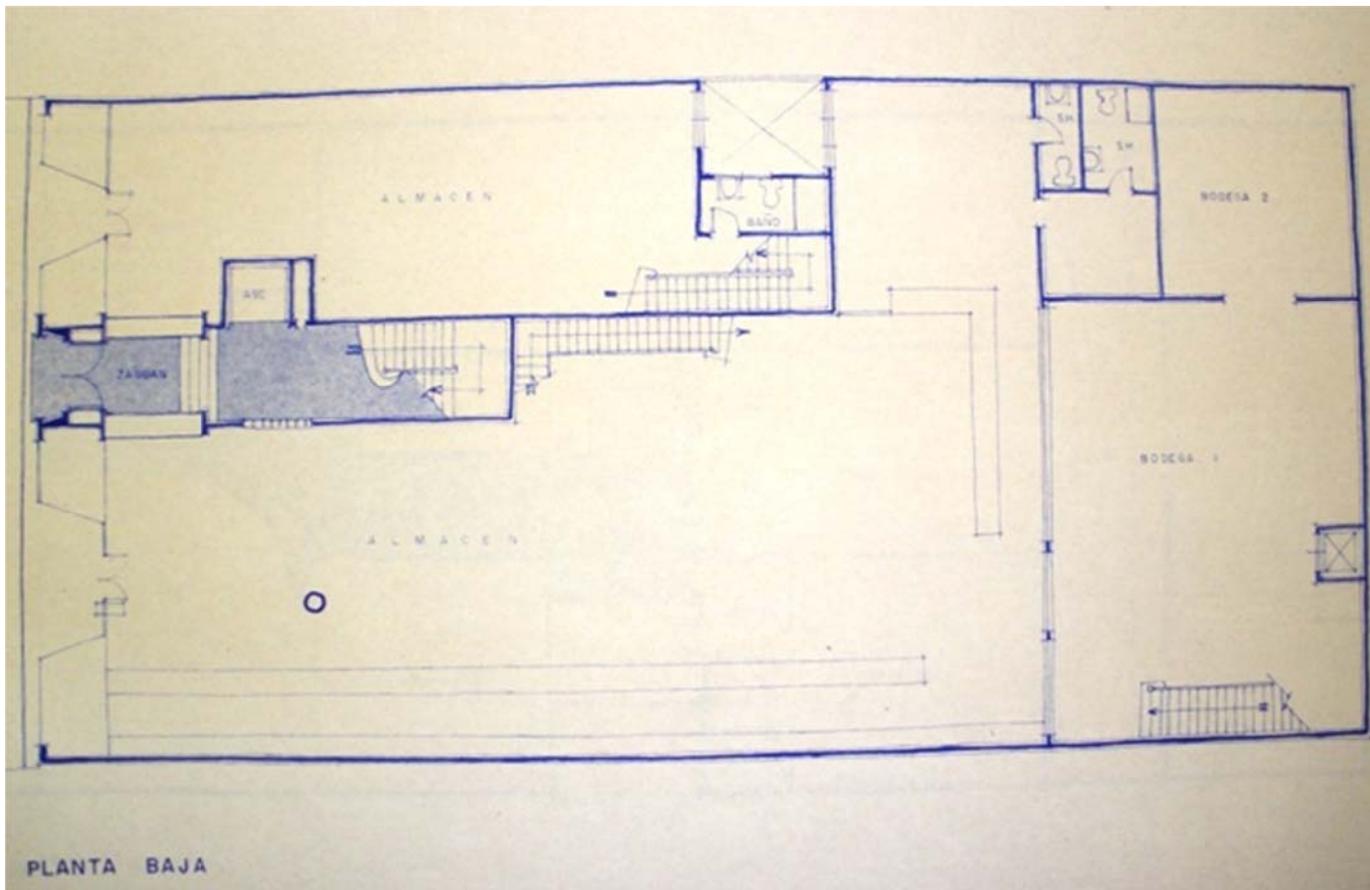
Planta baja. Fuente: Tesis Alcívar, Myriam; Lee, Pablo; Luque, Sandra; Rojas, Milton; Valdivieso, Francisco. Arquitectura Guayaquil 1930-1960
